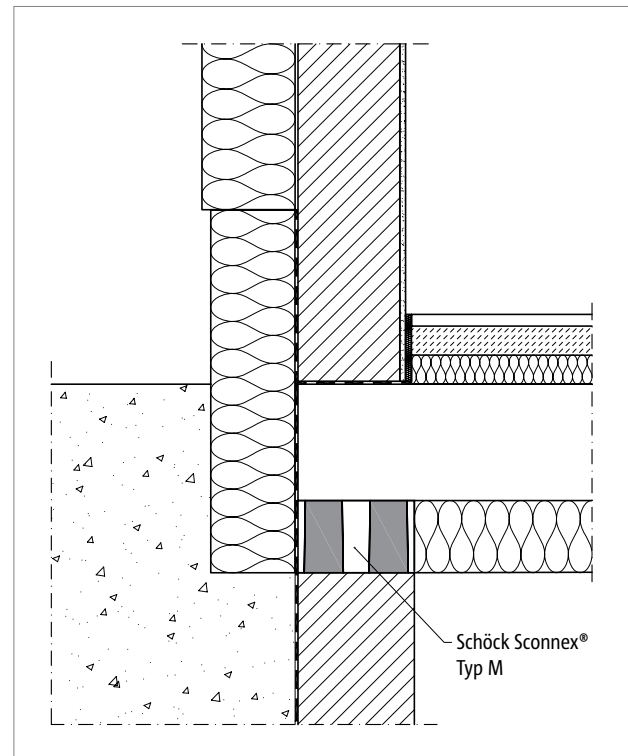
Schöck Sconnex® Typ M: Einbauzustand unterhalb der Kellerdecke
